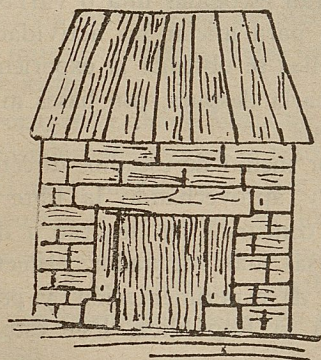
jacal con muro de adobe. Linteles de madera o piedra.
